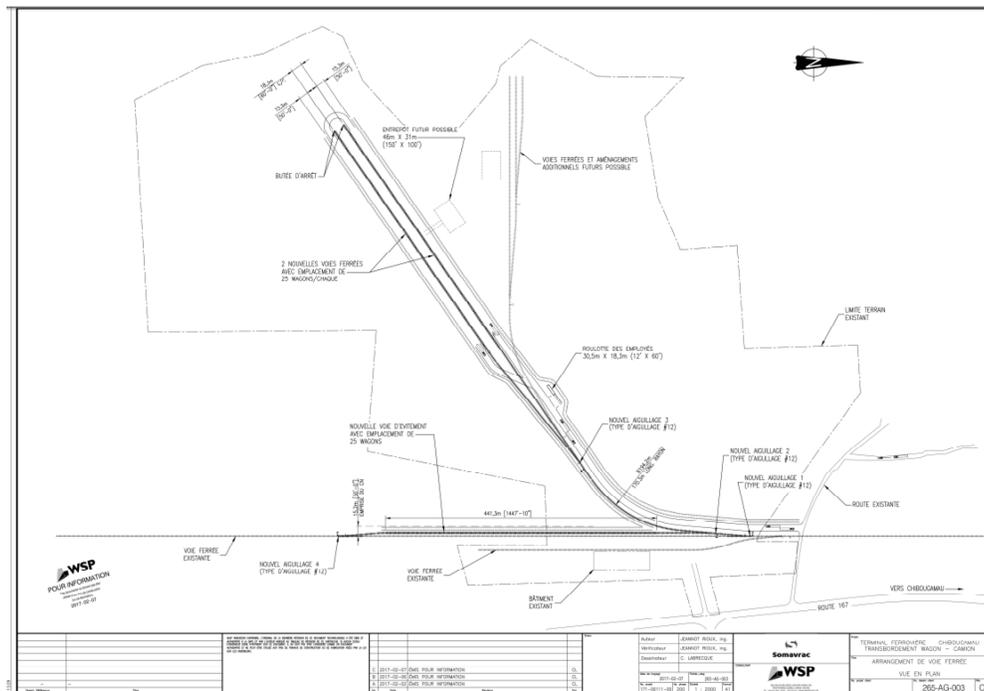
Plan préliminaire d'implantation du futur centre de transbordement de Chibougamau (Norda Stelo, 2018)
